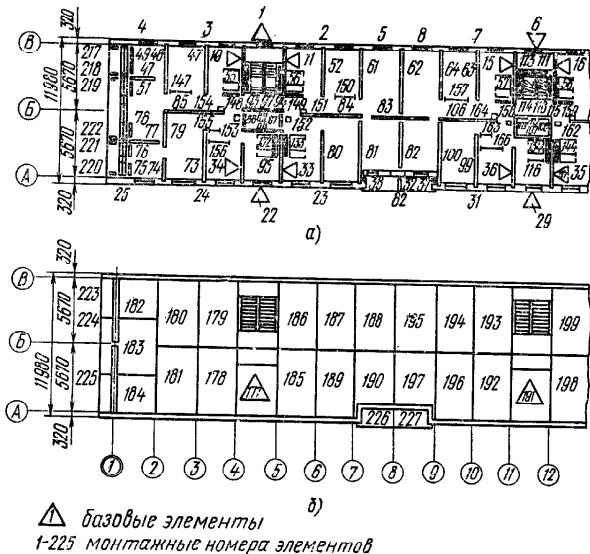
Монтажная схема жилого дома повышенной этажности:
